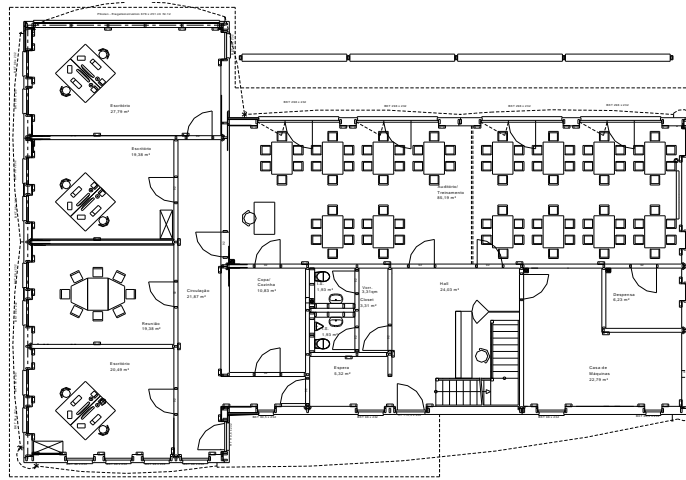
PLANTA BAIXA PAVIMENTO INFERIOR
